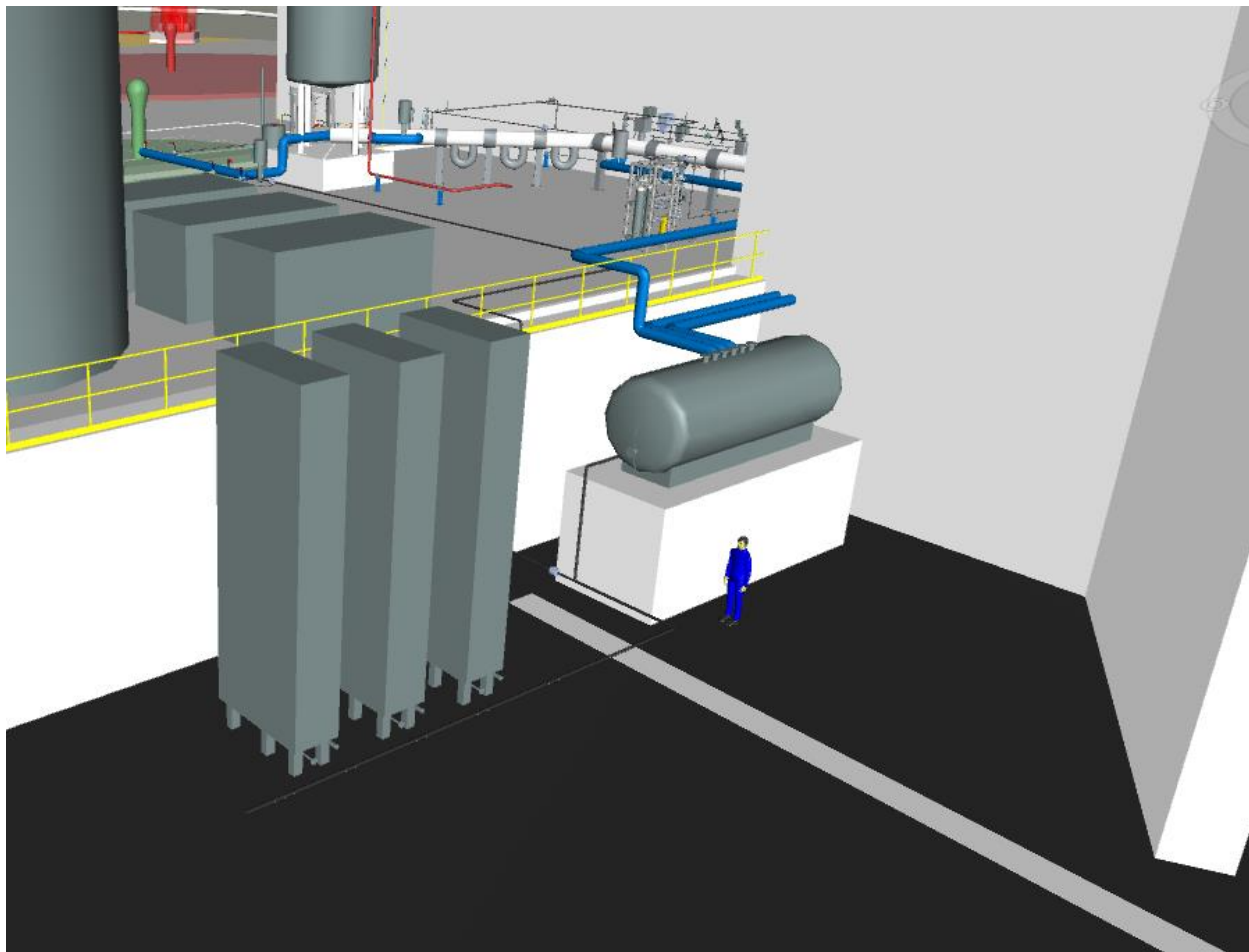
Vista tridimensionale vaporizzazione ossigeno
